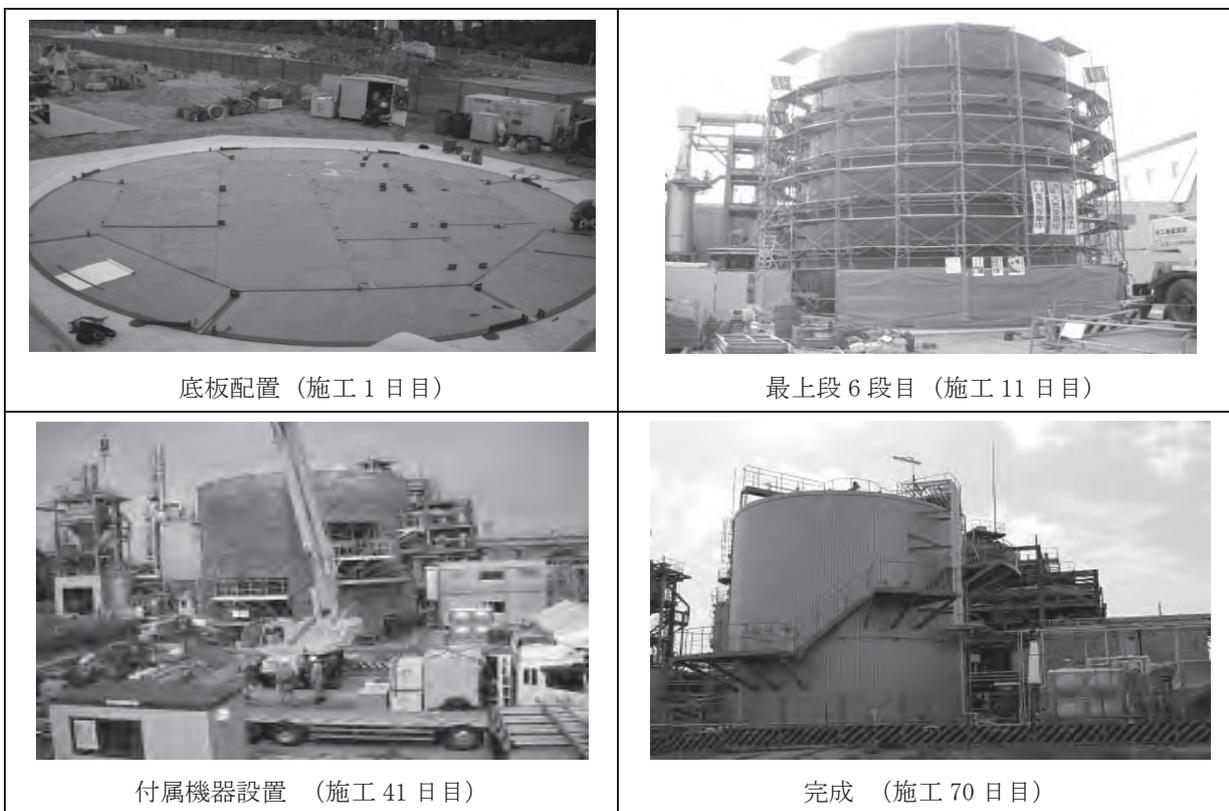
鋼板製消化タンク建設写真(注：施工前に基礎築造済み)
